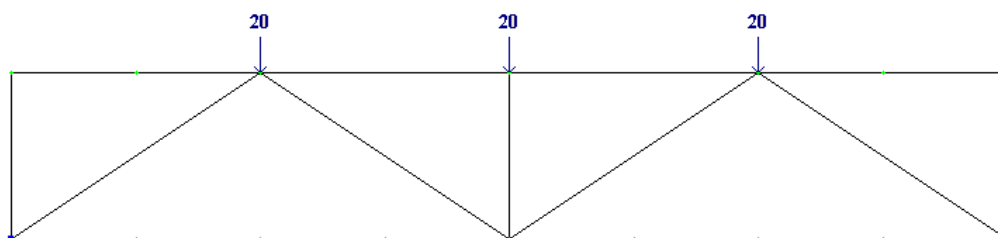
Розрахункова схема ферми з паралельними поясами
